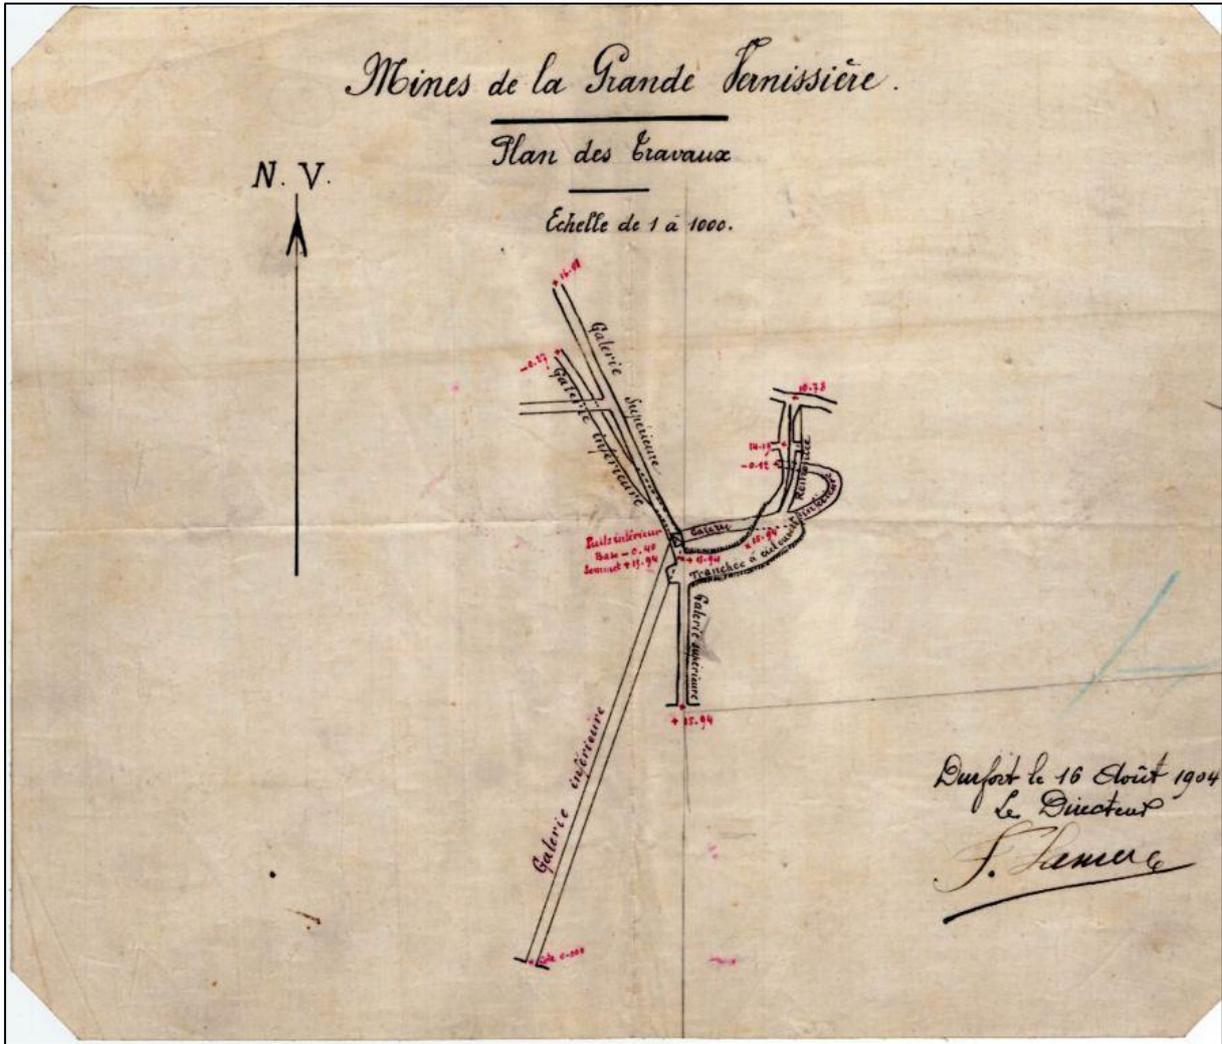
Plan des travaux de la Grande Vernissière en 1904
